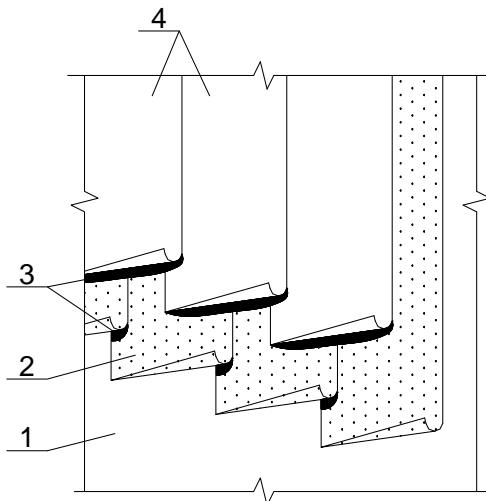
Кровля с нижним слоем из перфорированного рубероида:
